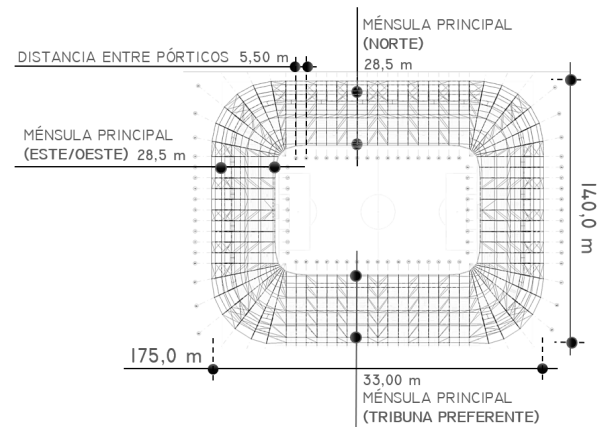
Esquema en planta de nuevo diseño de cubierta en anillo
